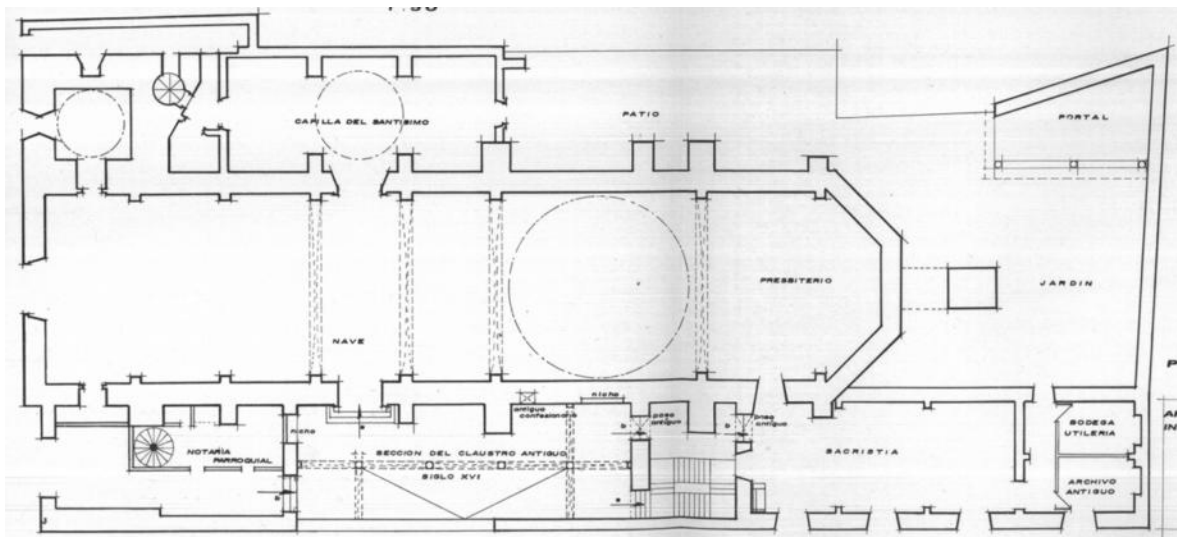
Proyecto de restauración de la Catedral de Tacámbaro derivado del sismo de 1985, Plano de planta restaurada. Juan Cabrera Aceves y Abel Pedraza Pedraza, *op. cit.*, anexo planimétrico.
